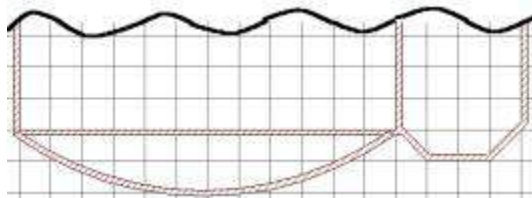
Фрагмент поверху будівлі №1.2
